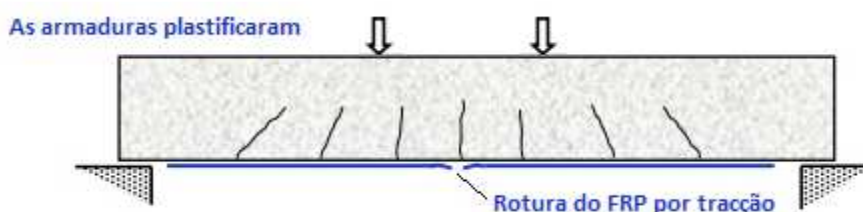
Rotura do material de reforço após plastificação das armaduras [adaptado de 52]
